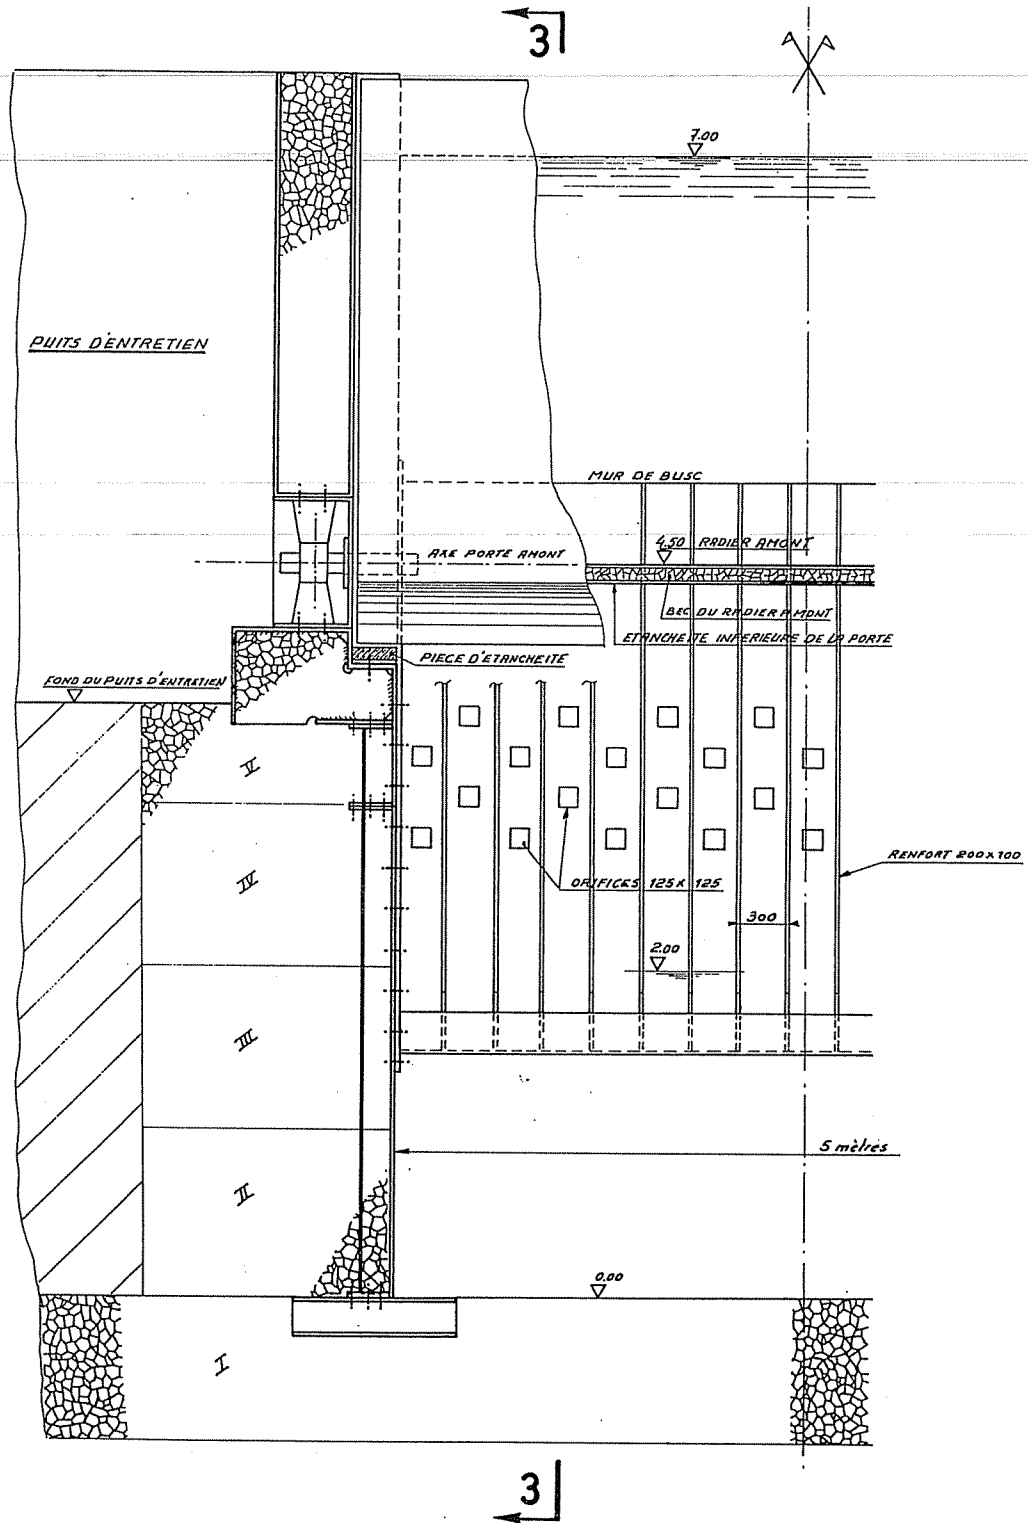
Plans et coupes dans la tête et la porte amont.
